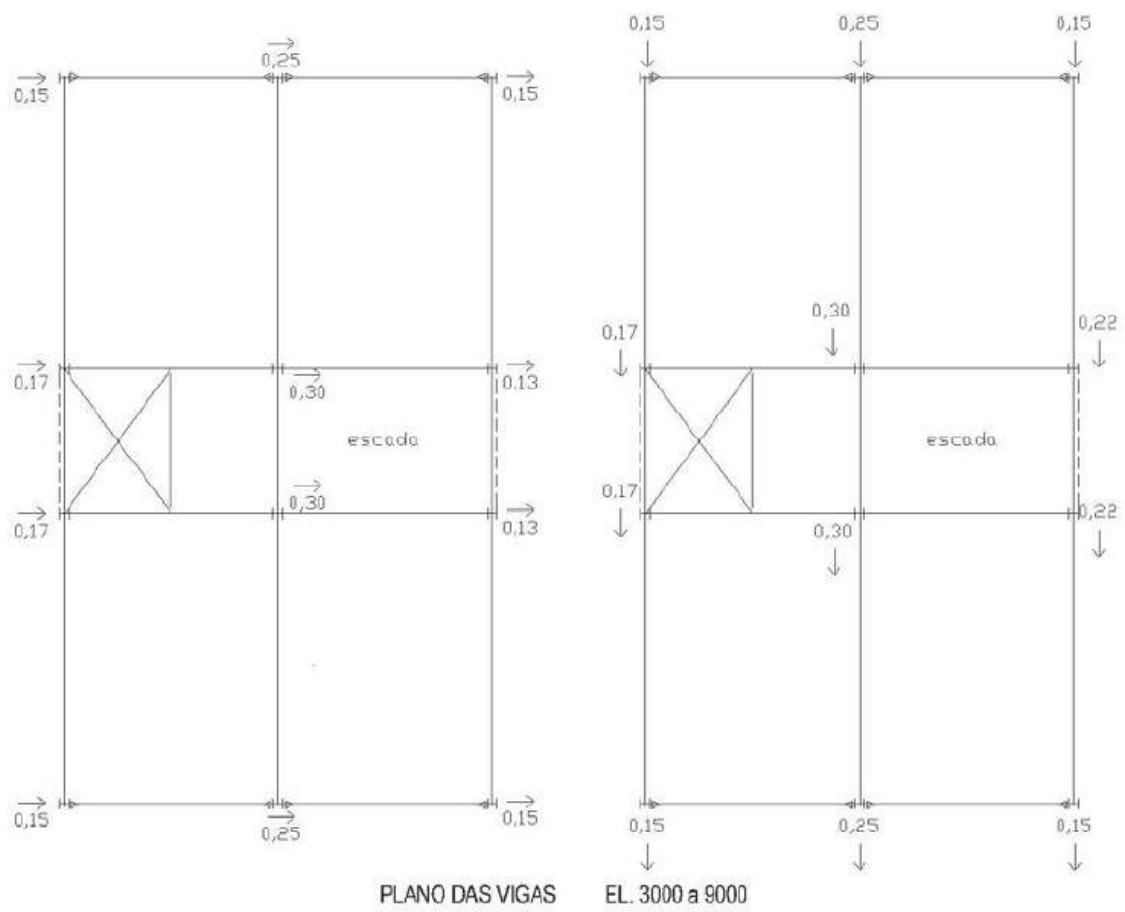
Forças Nocionais nos planos das vigas do pavimento tipo. Fonte: INSTITUTO AÇO BRASIL et al., 2011.
